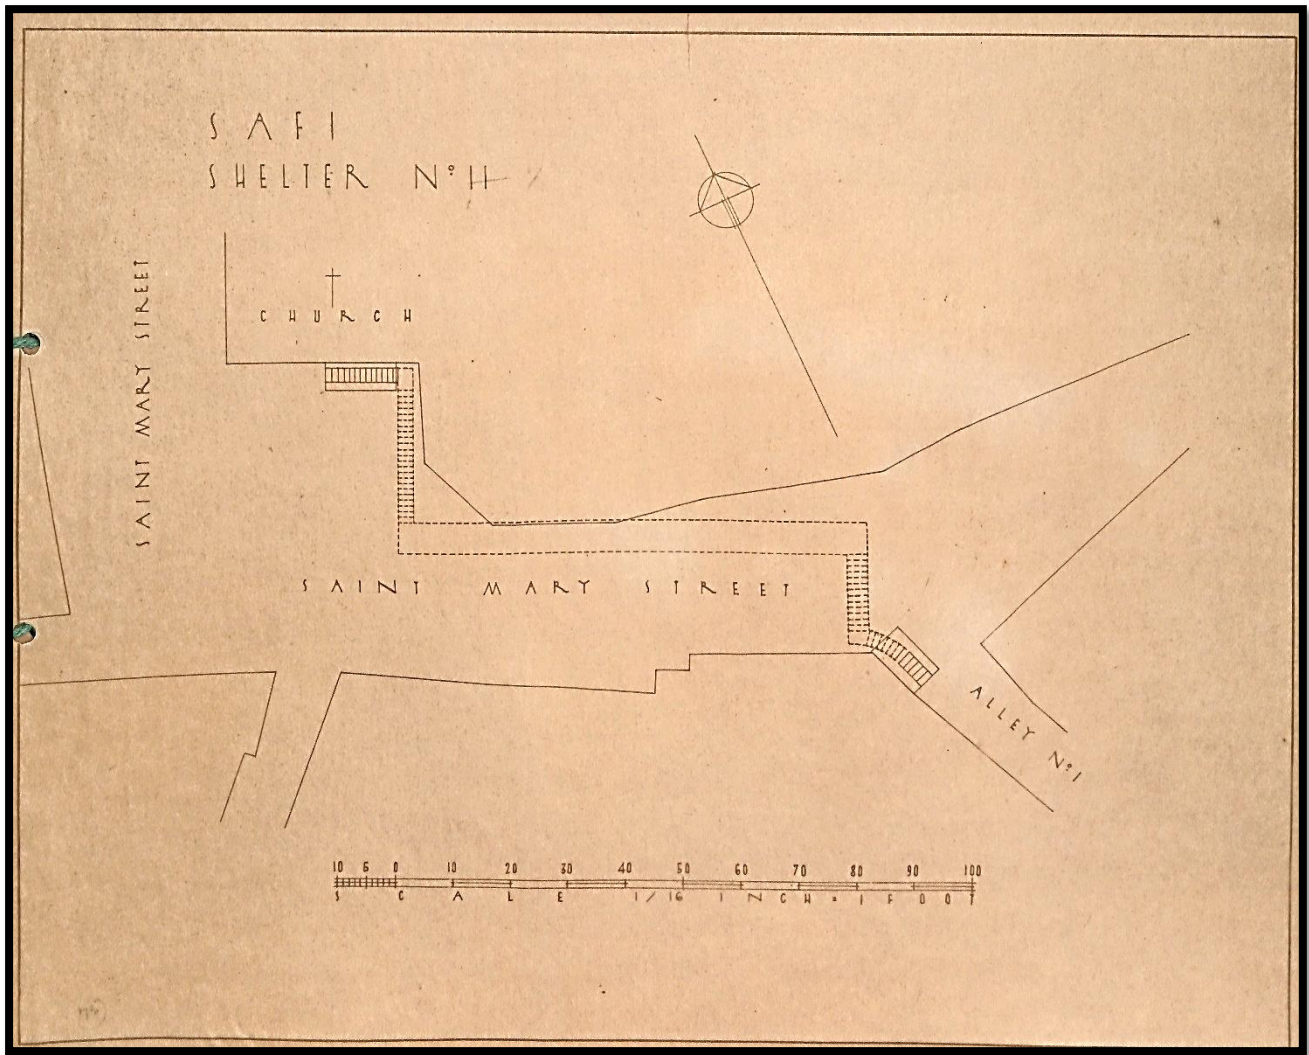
Planta do Abrigo nº11 (7) "Saint Mary Street – Alley nº1."
